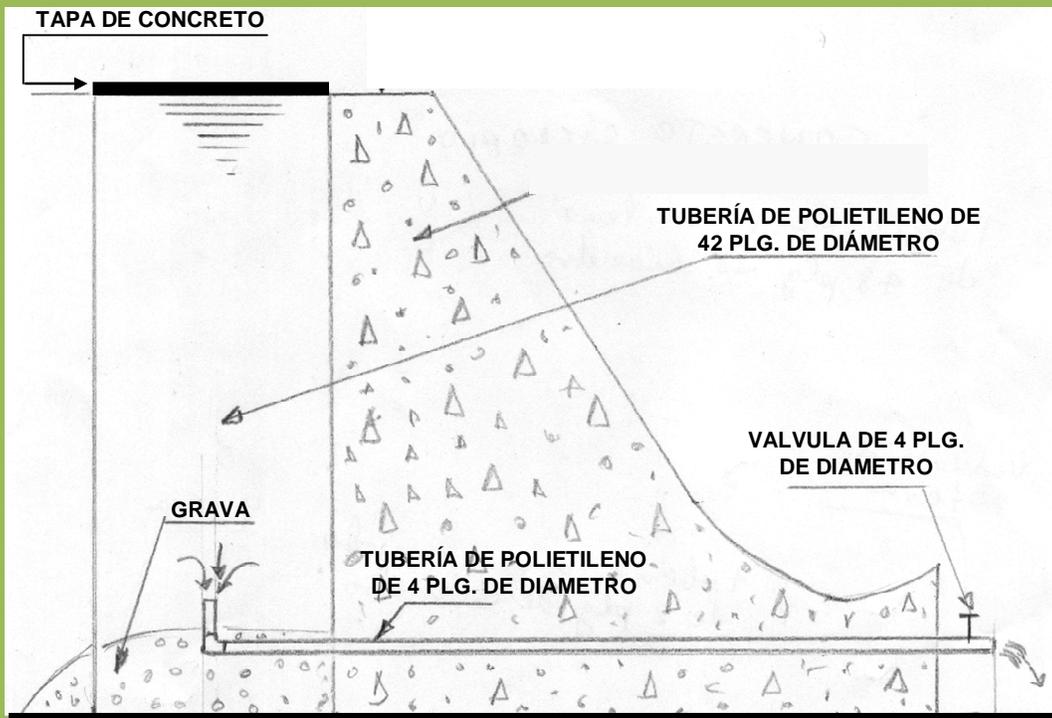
Esquema de obra de toma de la presa de mampostería en Sacramento.
